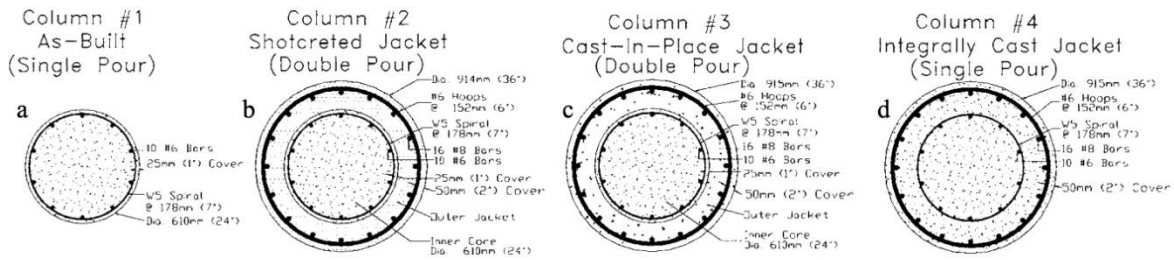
Secciones transversales de las columnas ensayadas de Hamilton et al. (2004)
